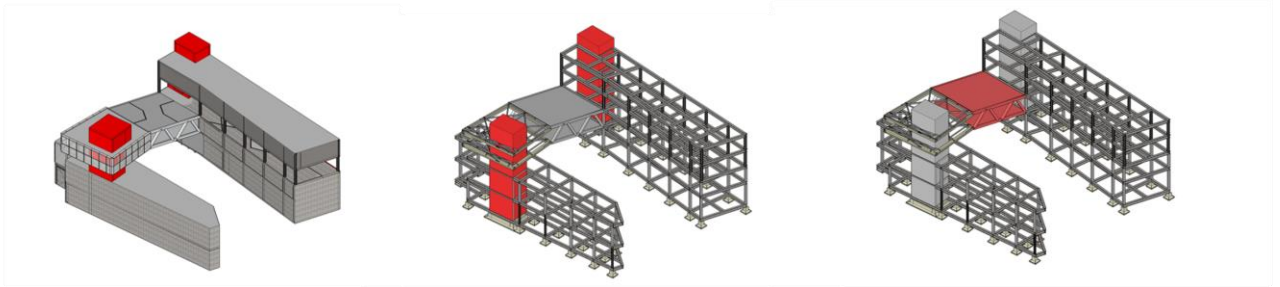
Esquemas estructurales: puntos fijos, viga vierendeel, vigas y columnas. Imagen del autor
